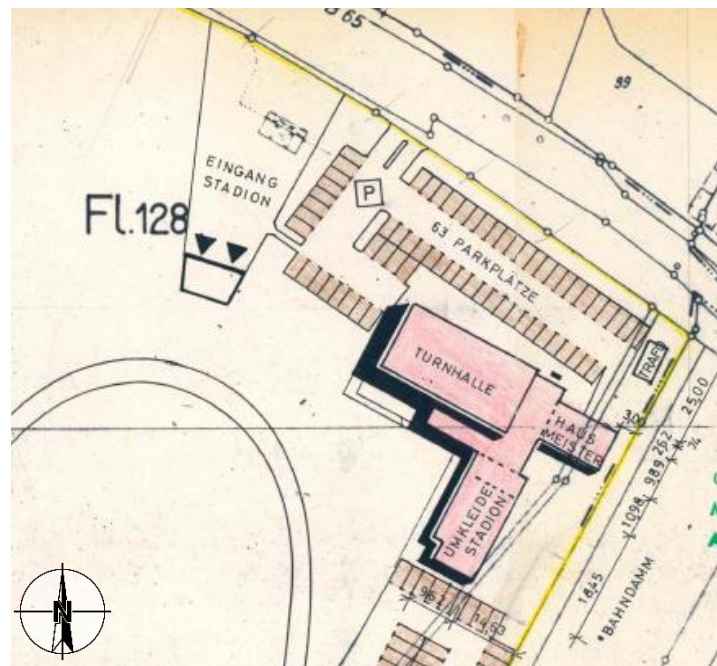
Grundriss mit Bestandsgebäuden [U4.1]
